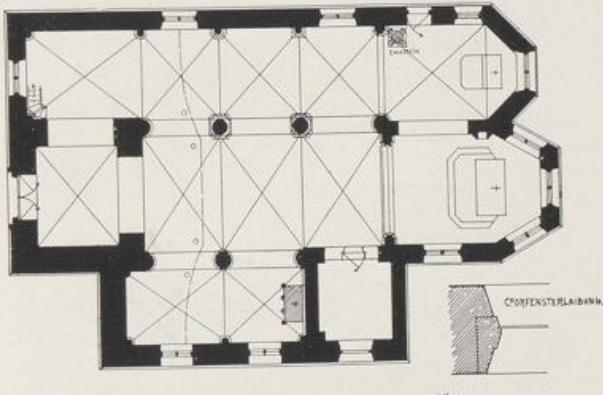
Drove. Grundriss der kathol. Pfarrkirche.
